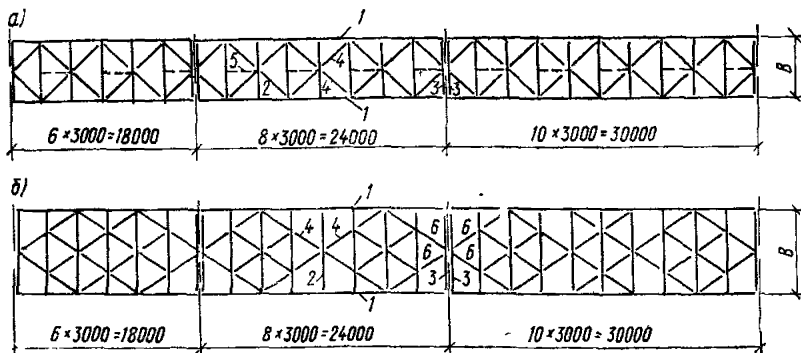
План балок и связей перекрытия для сборных железобетонных плит длиной 3 м
